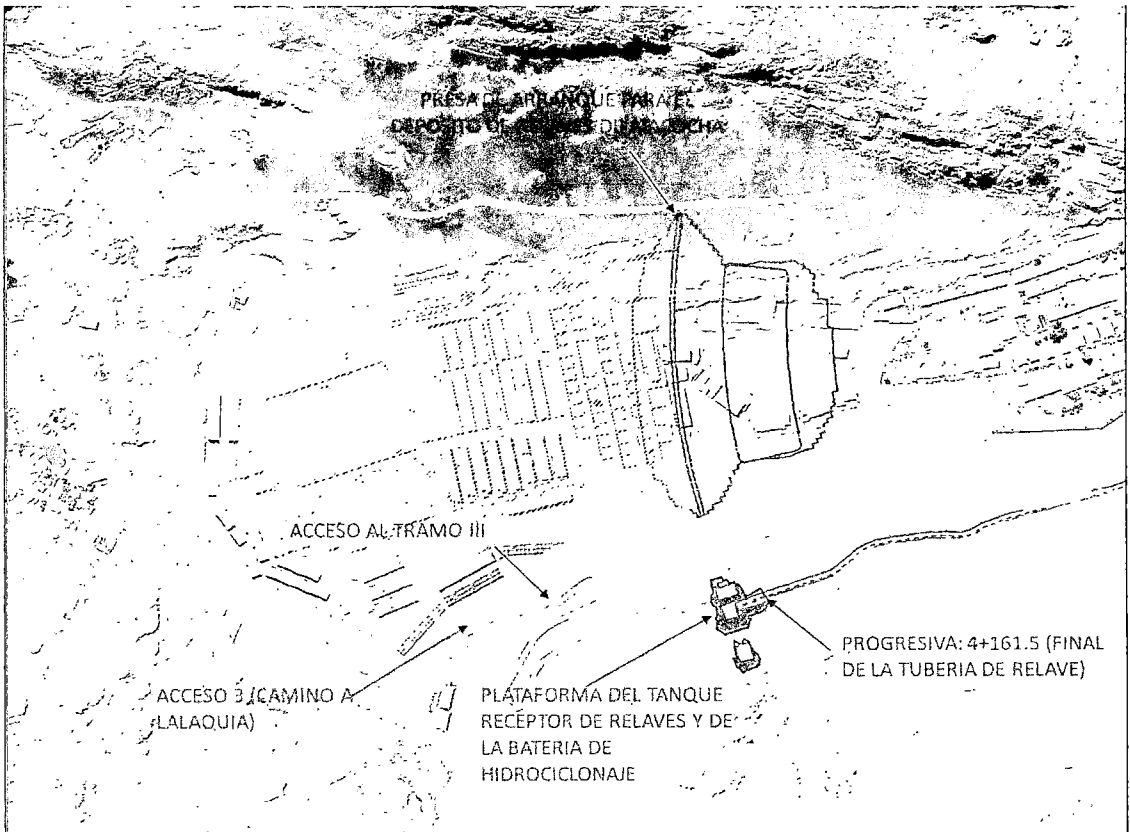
Ubicación de la Plataforma de llegada de la línea de Impulsión
